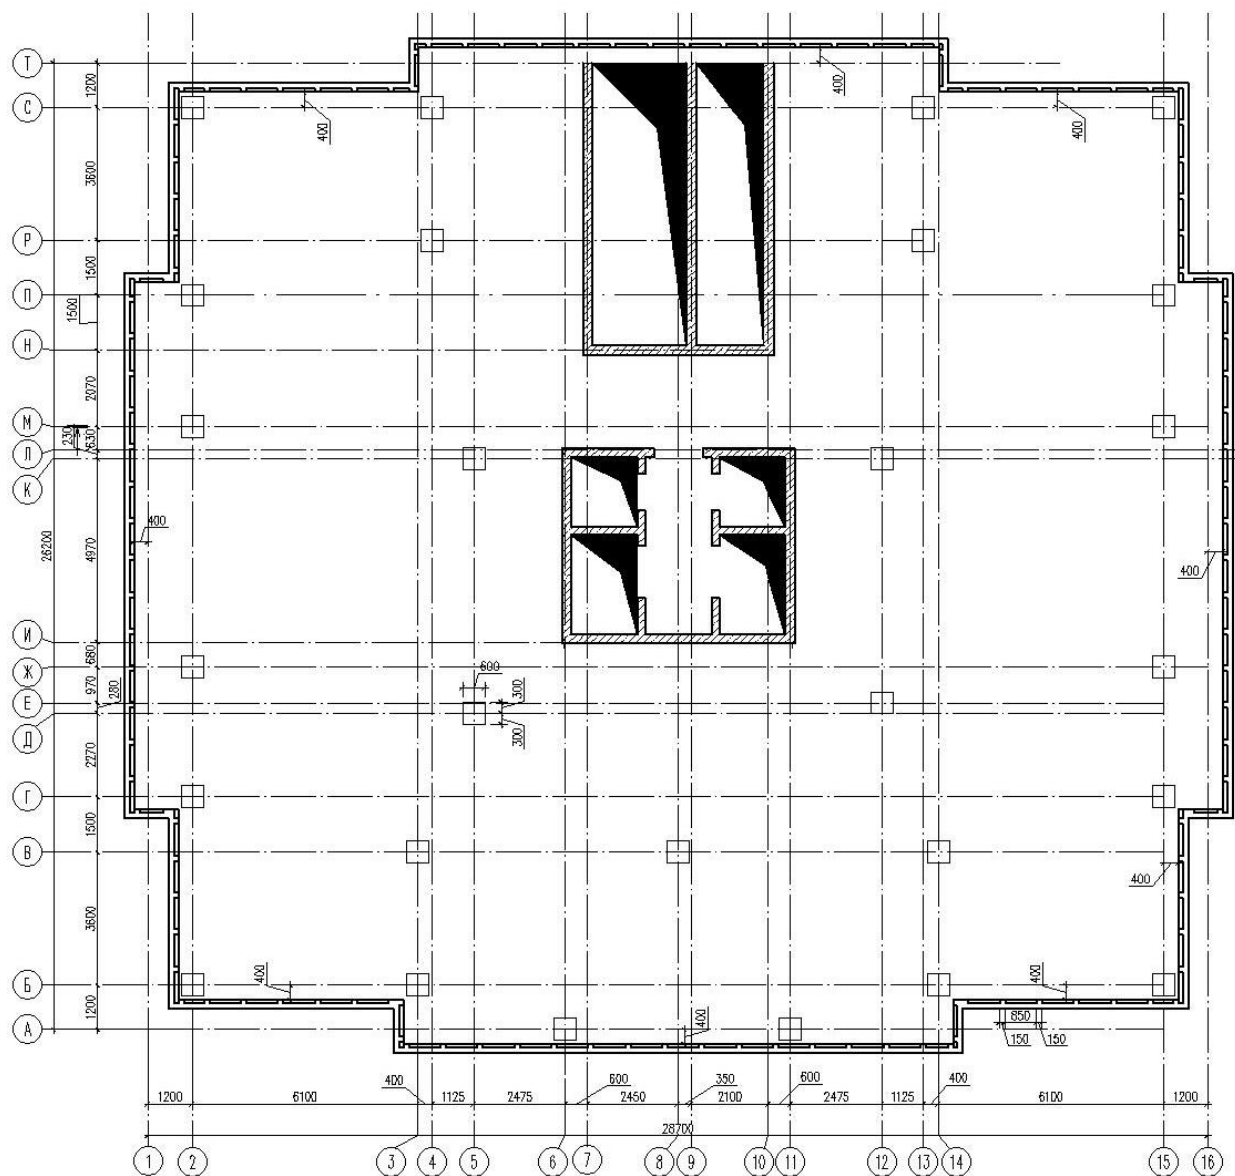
Опалубочный чертеж плиты перекрытия на отм.+3.600
